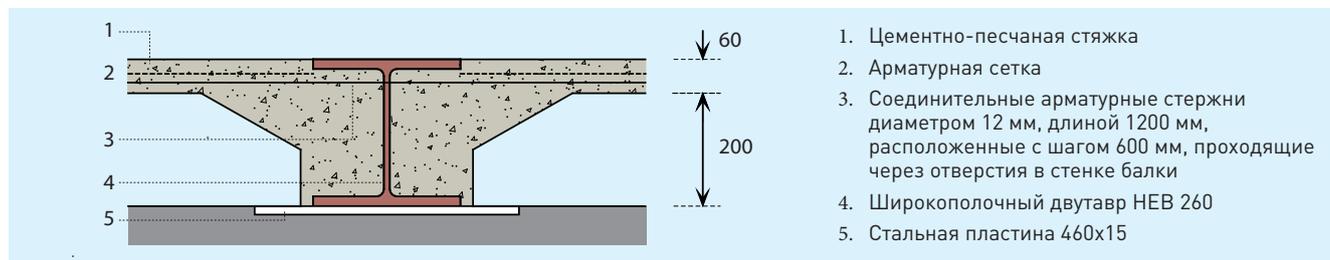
Типовое сечение перекрытия со встроенными балками и сборными плитами
